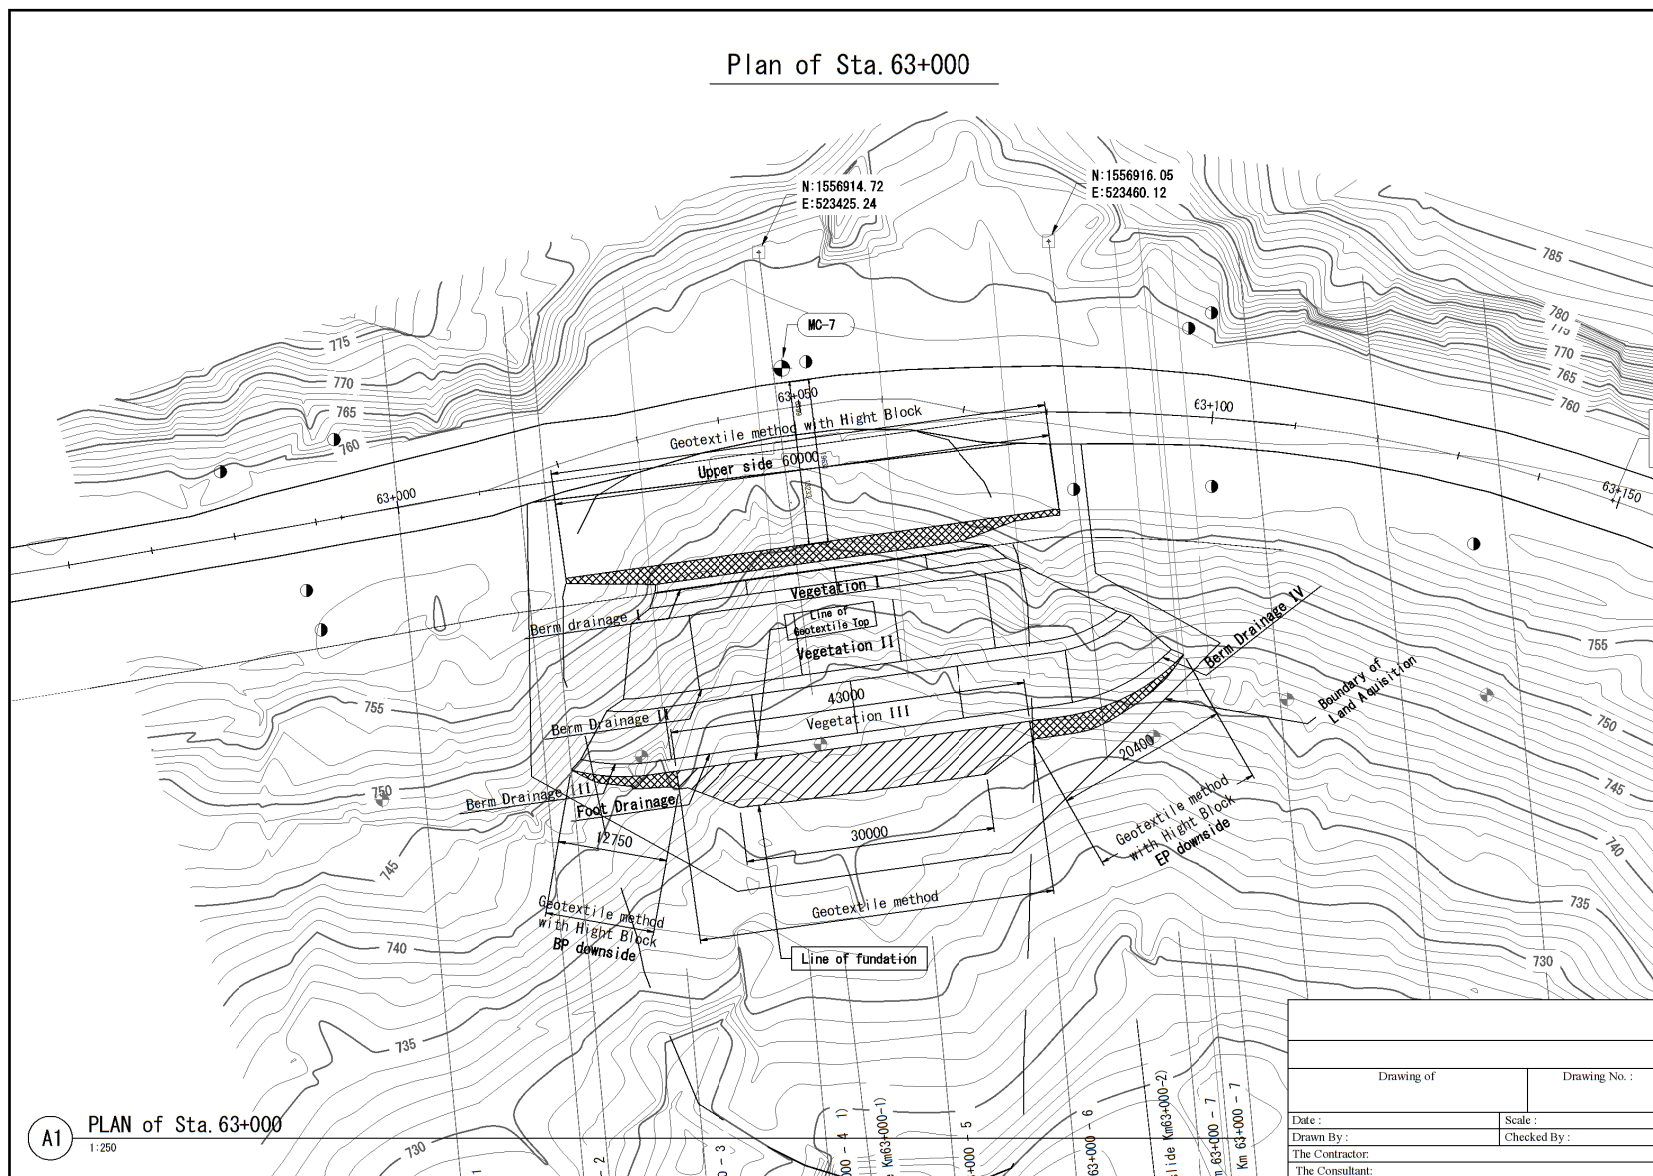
Sta. 63+000 平面図 (Non-Scale)
